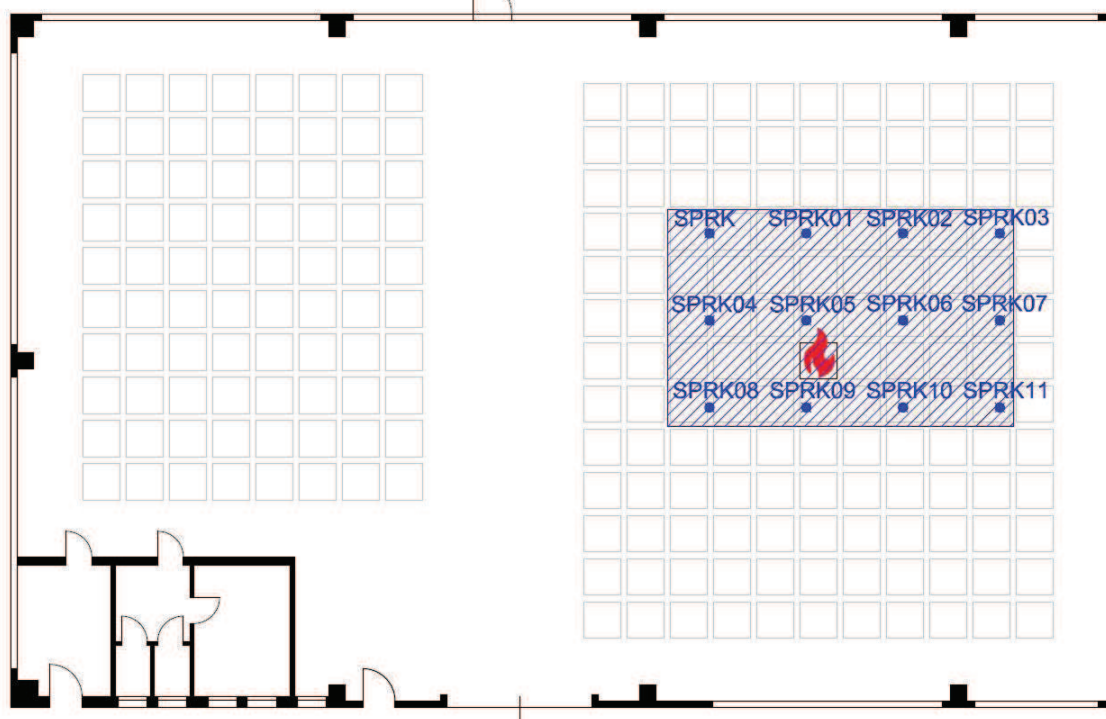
Collocazione in pianta delle testine sprinkler per lo scenario d'incendio collocato nell'Area B.
